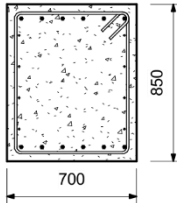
Detail Penulangan Balok Gedung Tipe A
